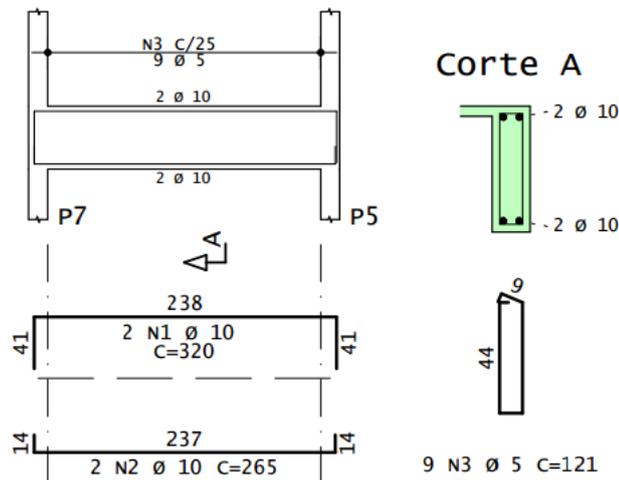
Armadura da viga V7 – pavimento superior (nível +3,00)
